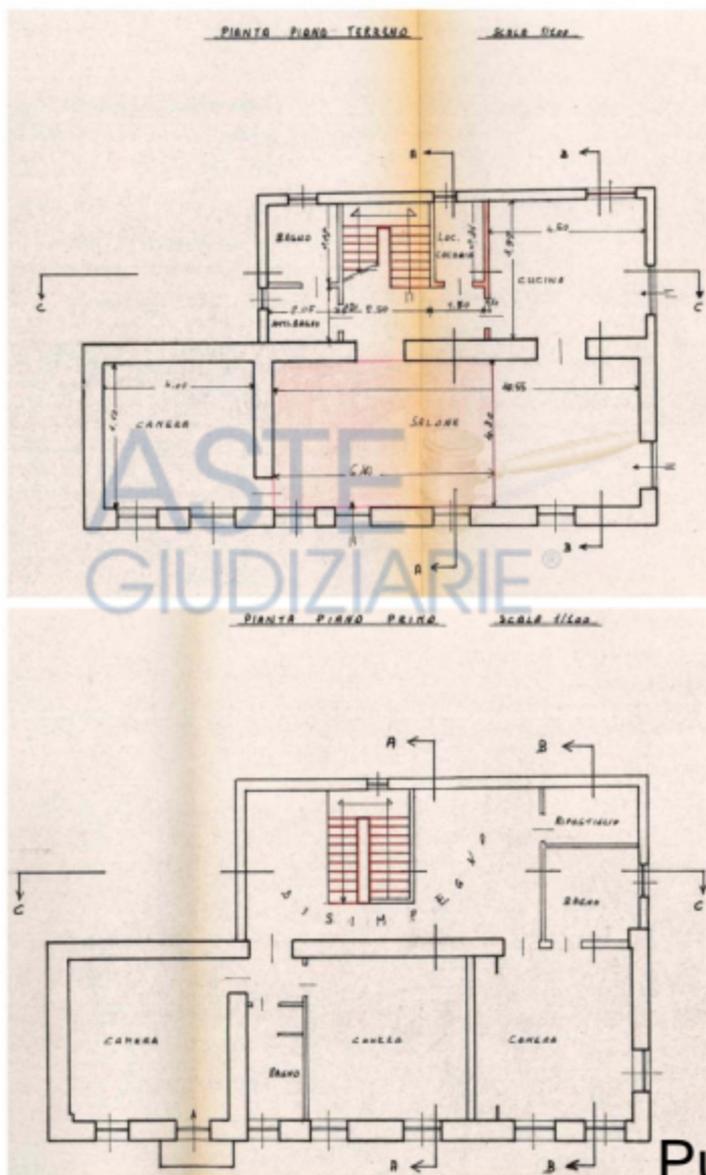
planimetrie estratte dalla tavola grafica allegata all'Aut. Edilizia n. 552/1989 - scala indicativa
